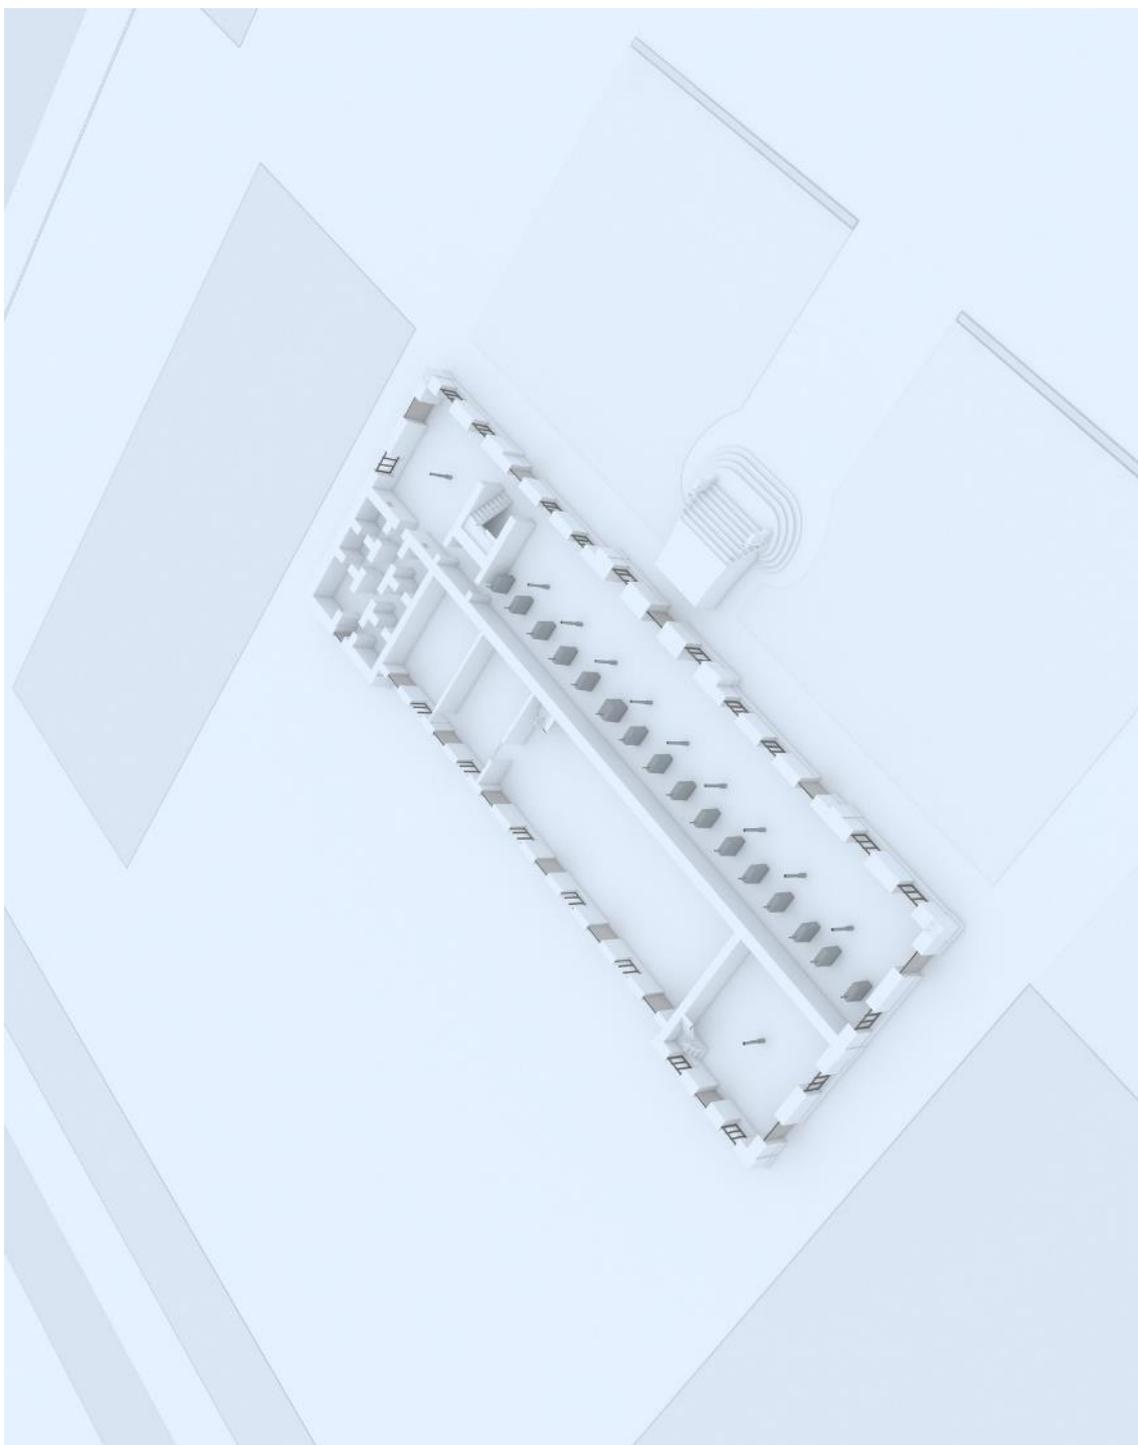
Imagen virtual. La fábrica. Planta segunda. Sección por debajo de las vigas gemelas.
